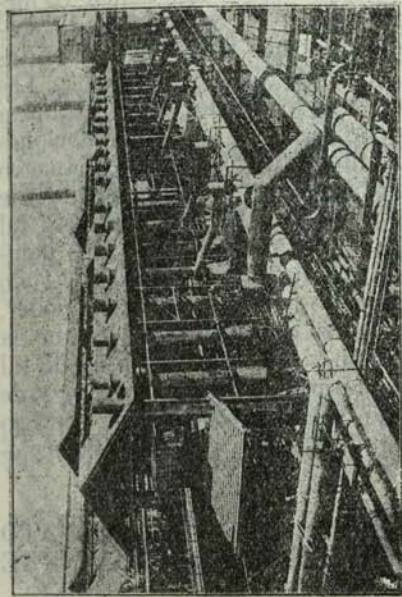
Construcciones de gasógenos para la fabricación de gas de agua.
